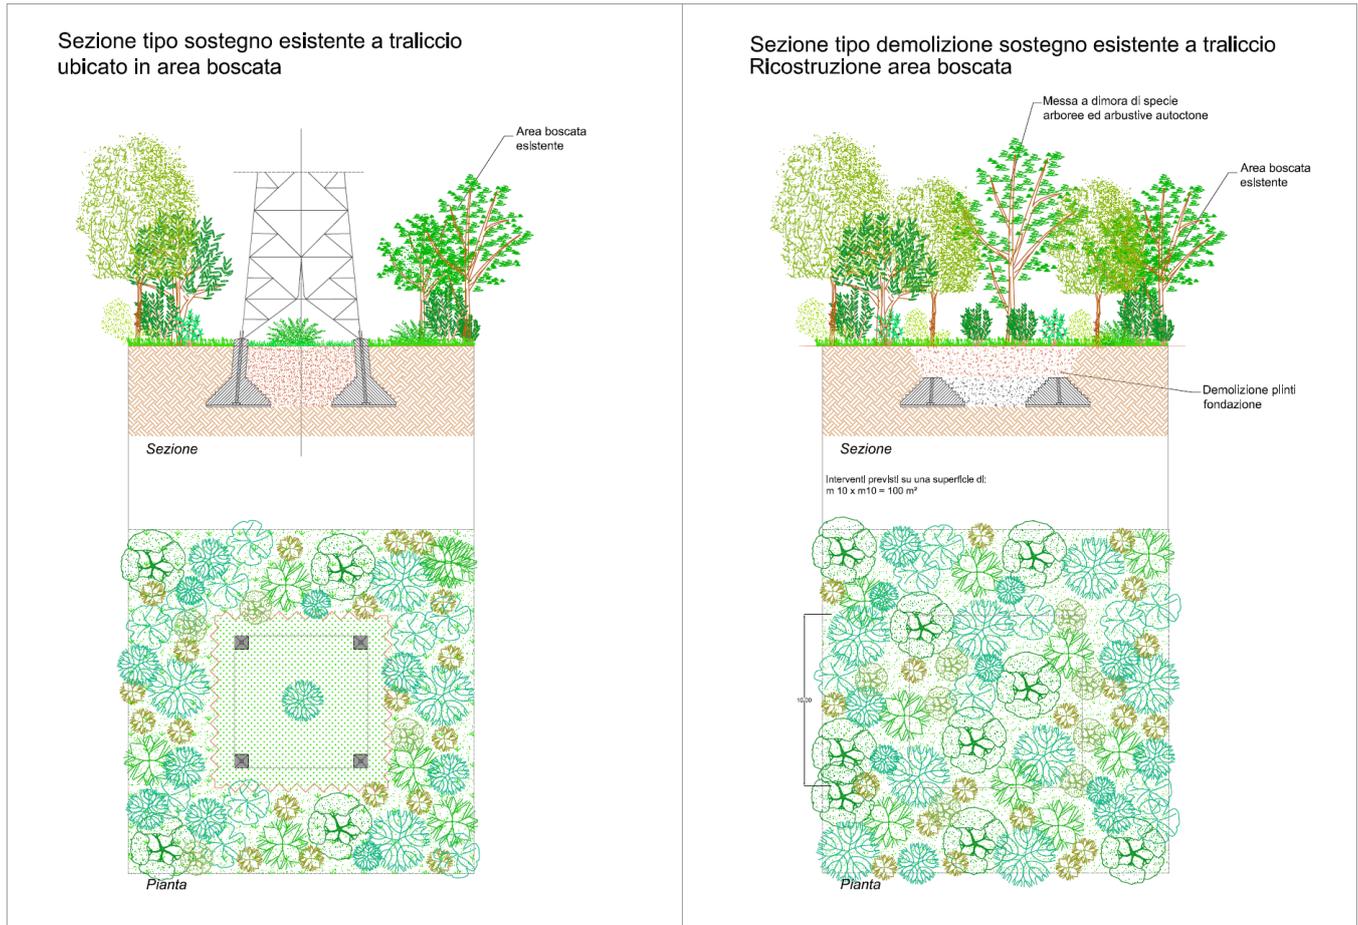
Sezione tipo e pianta Intervento Ricostruzione area boscata
